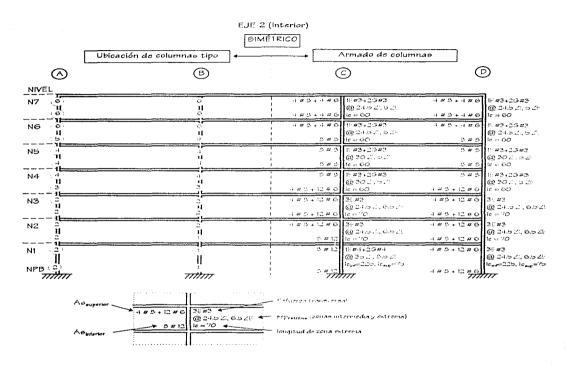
Uticación de los tipos de armados de las columnas del eje 2 de la estructura diseñada en la zona il
